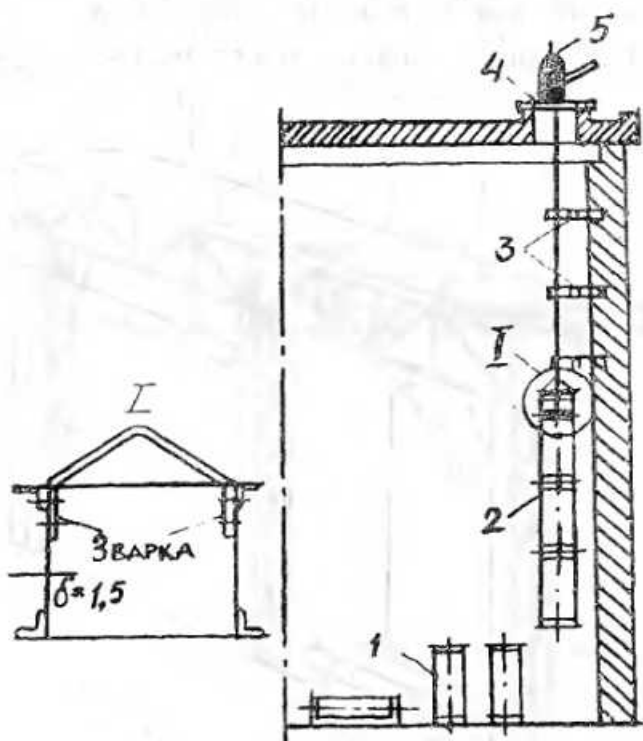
Схема монтажу вертикальних повітропроводів способом підрощування знизу: 1 - елементи повітропроводу; 2 - ланка повітропроводу; 3 - кронштейни; 4 - монтажна балка; 5 - важільна лебідка
